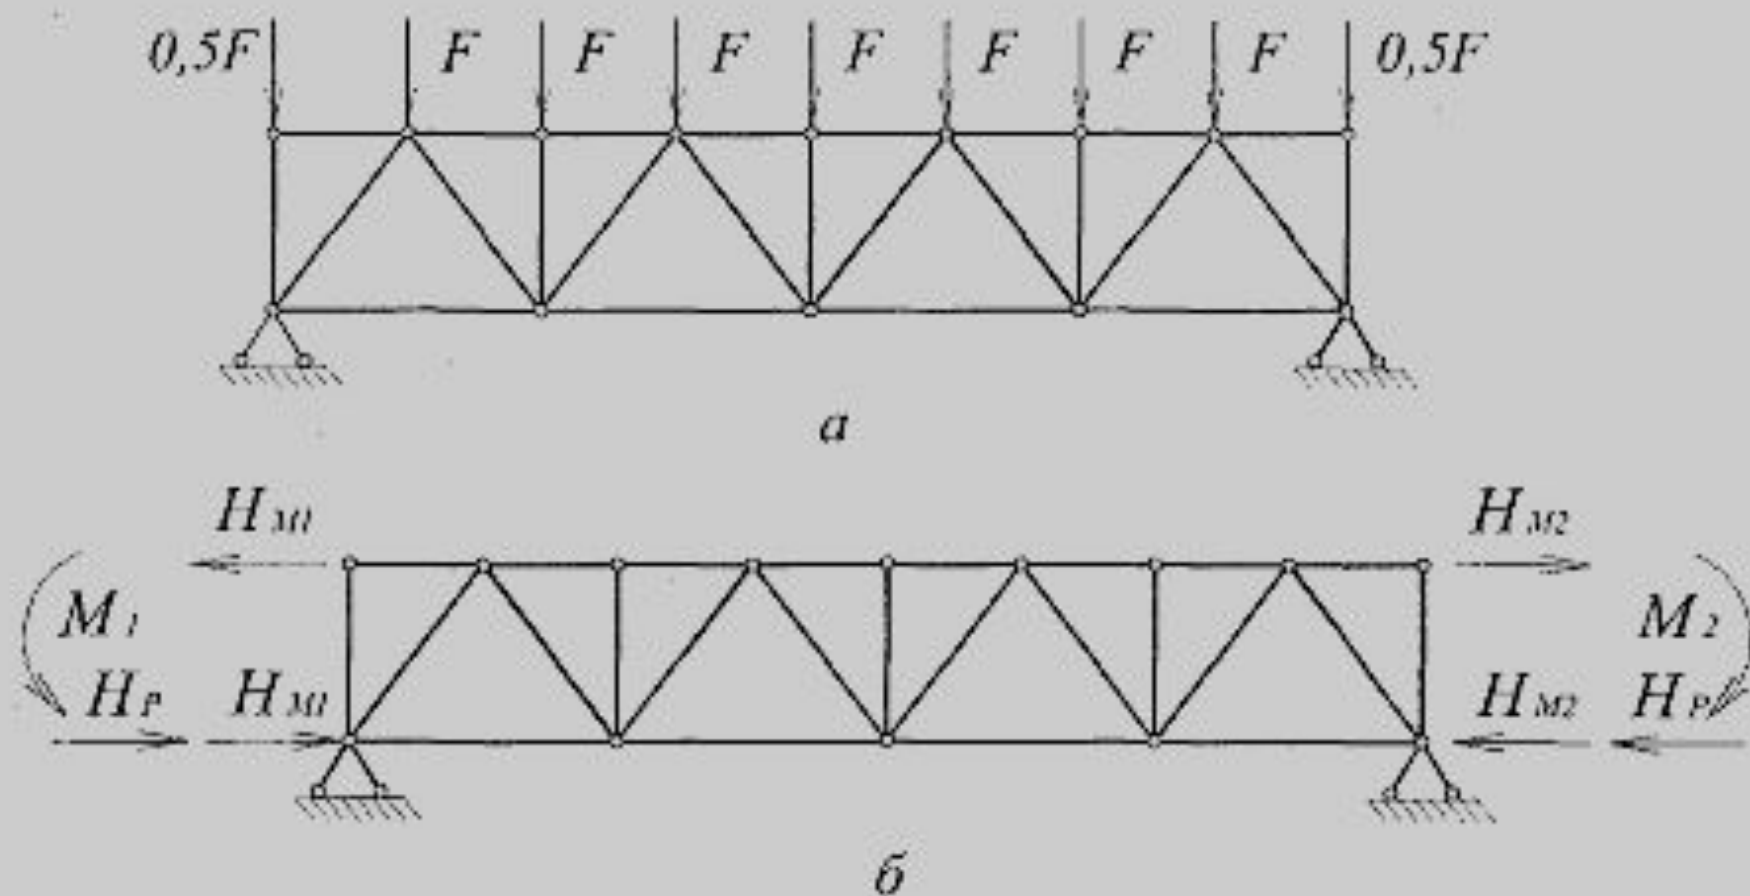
До розрахунку ферм при жорсткому спряженні з колонами:
